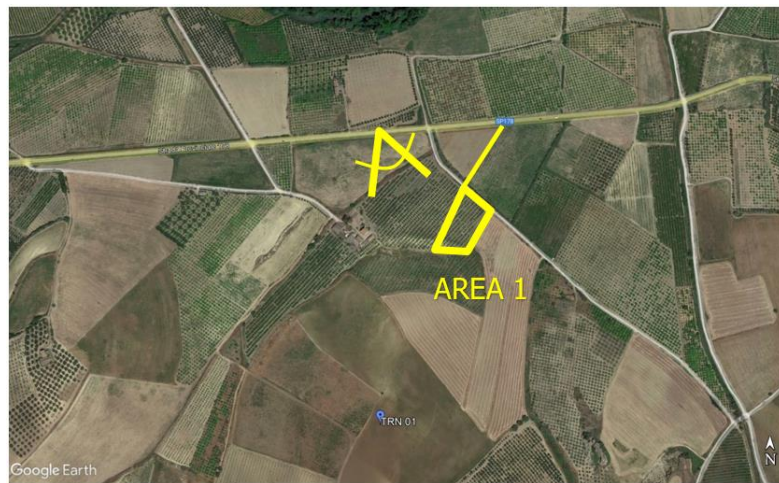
Vista area dell'area di cantiere denominata AREA 1 a nord del TRN01
